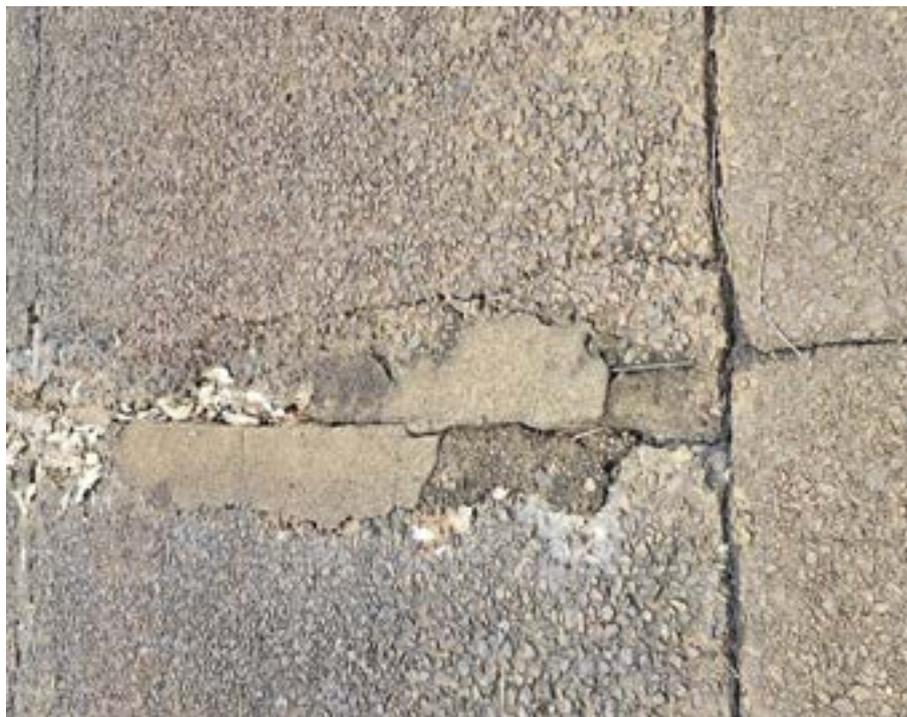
Camada de recobrimento das armaduras removida devido a fissuras e deterioração.
